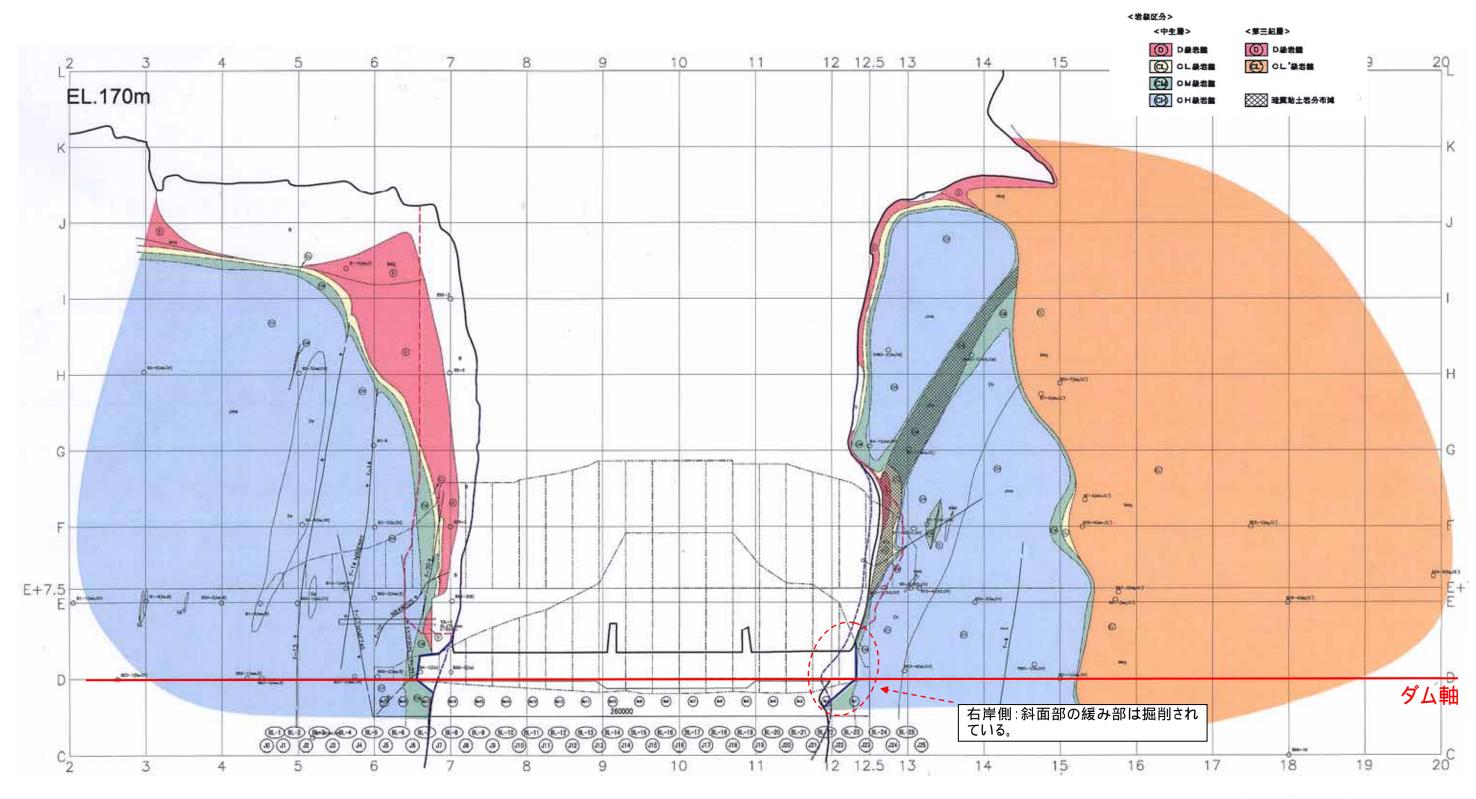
丸山ダムの基礎岩盤の状況(EL.170m 岩級区分水平断面図)
